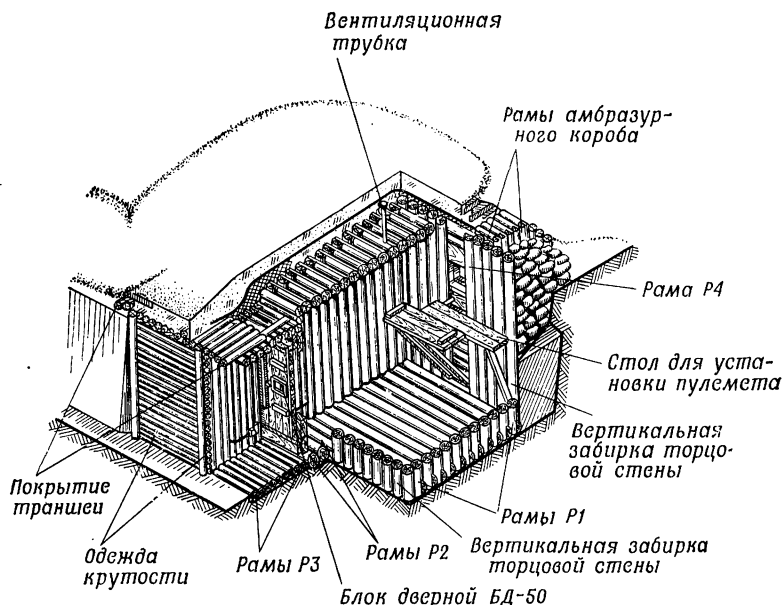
Сооружение с остовом рамной конструкции для стрельбы из крупнокалиберного пулемета (общий вид)
